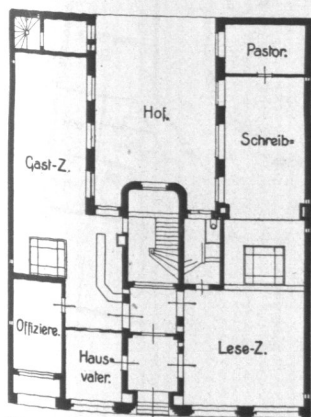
Deutsches Seemannsheim am Wolfgangsweg, Erdgeschoß, Grundriß.
